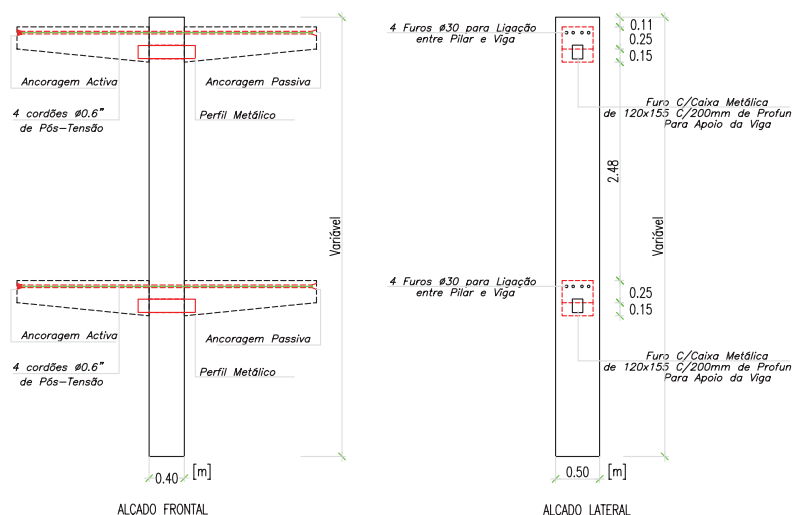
Alçado dos pilares das rampas com continuidade das vigas [62]
